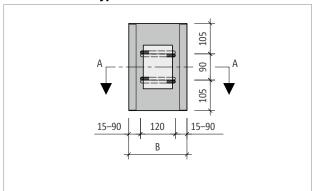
Schöck Sconnex $^{\odot}$ Typ W-N-VH: Produktgrundriss; Positionierung der Querkraftstäbe
